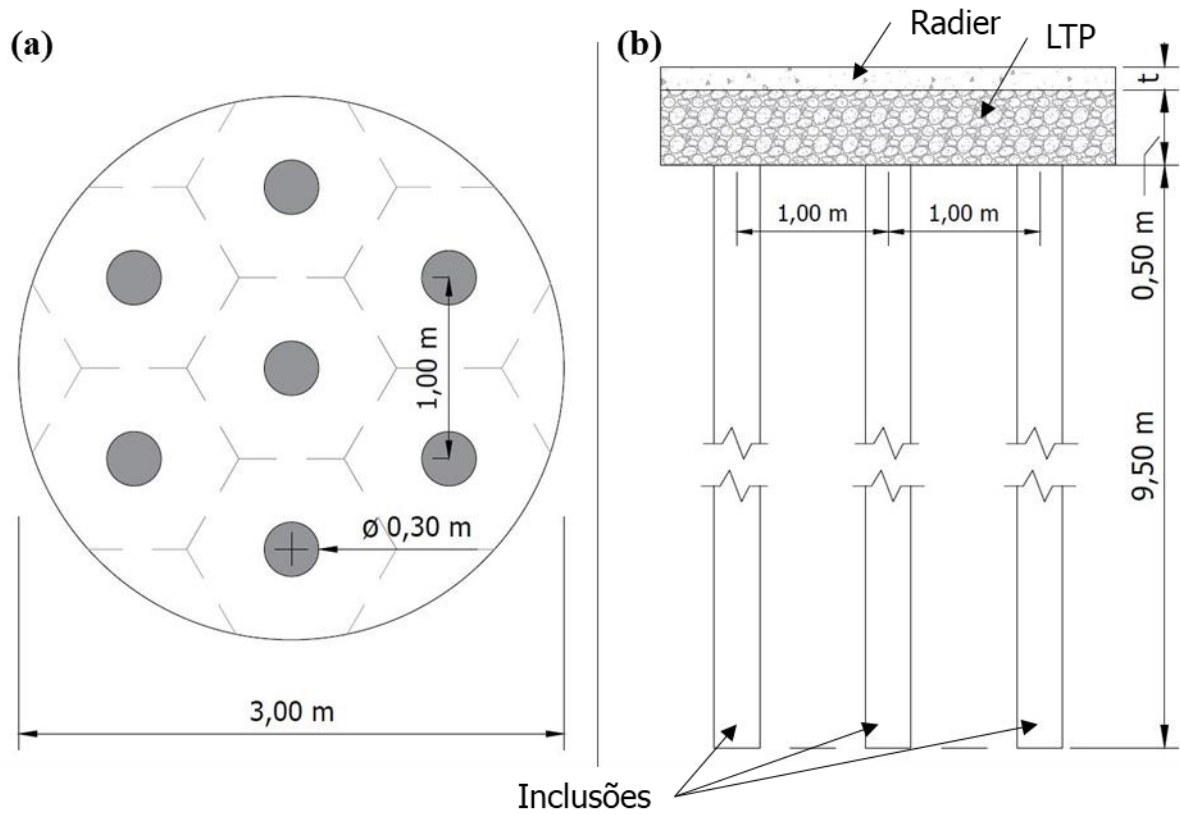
Croqui de modelo reforçado com inclusões rígidas (a) vista em planta e (b) vista em corte
